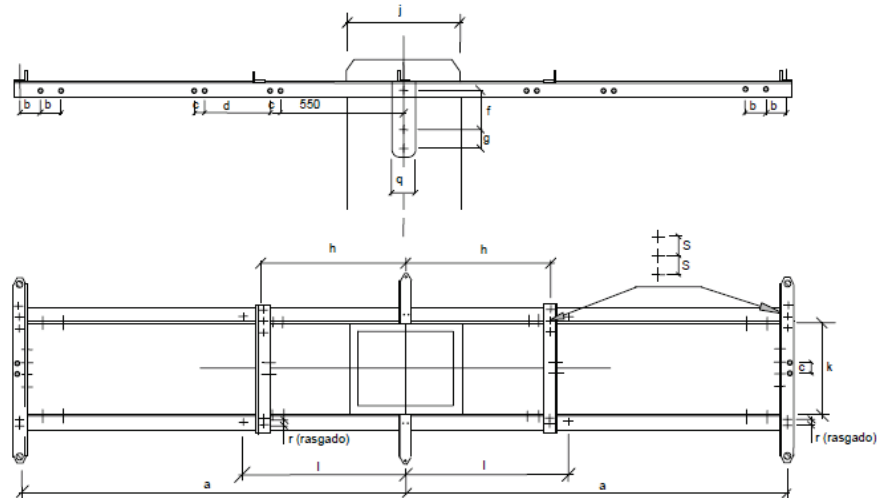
Cruceta recta tipo RH2 para apoyos de hormigón, chapa o presilla
